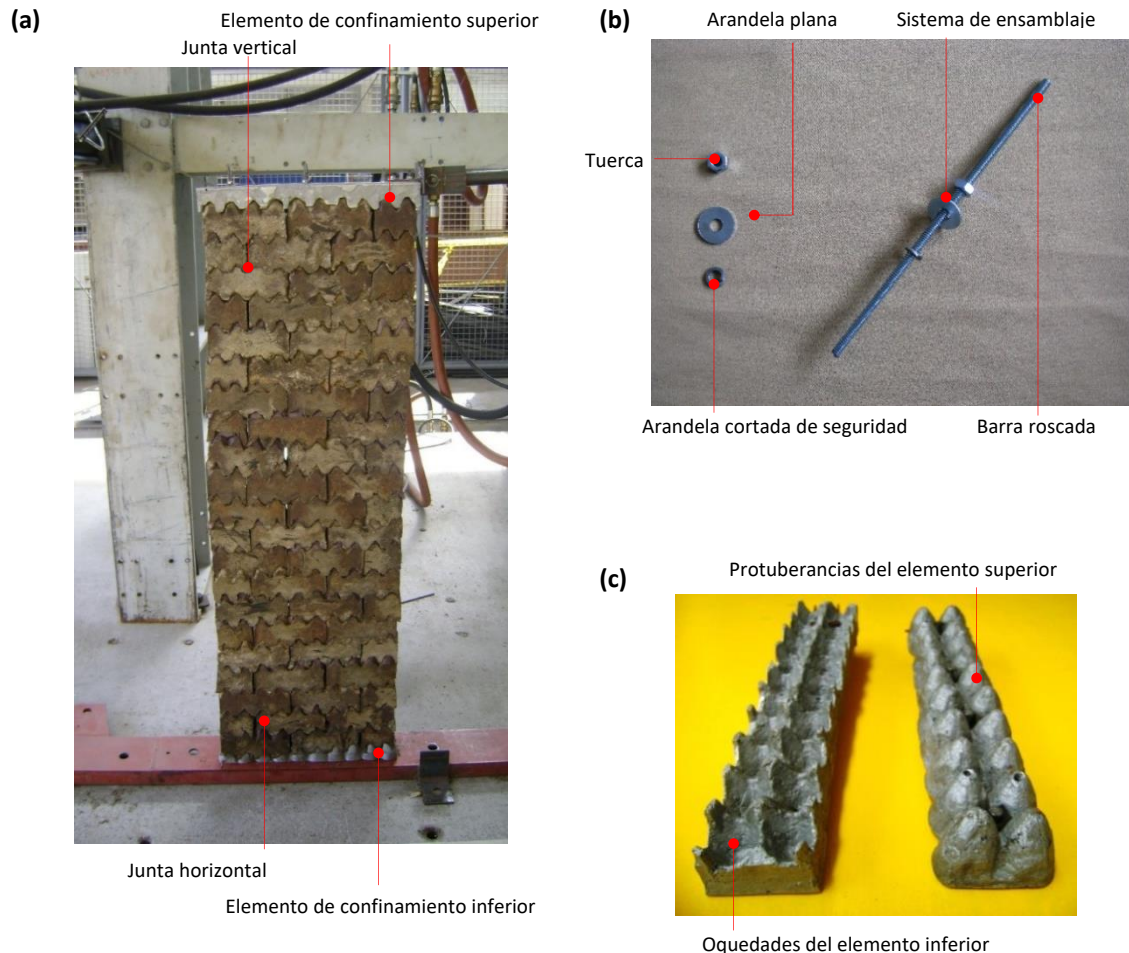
Detalle y componentes del panel. (a) Vista frontal del panel, (b) Refuerzo longitudinal y (c) Elementos de confinamiento.
